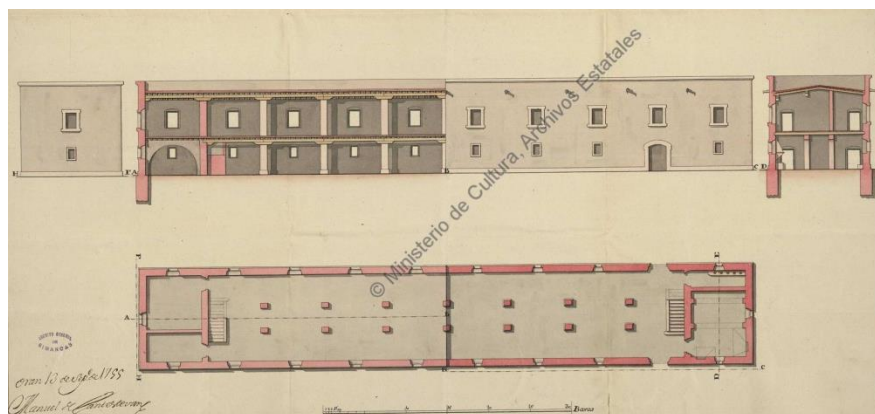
El plano, perfil y elevación de otro cuartel de infantería en Orán
